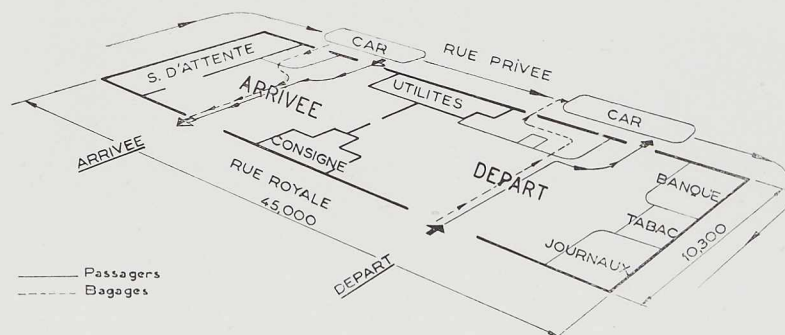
Plan du terminus urbain de la Sabena à Bruxelles.
